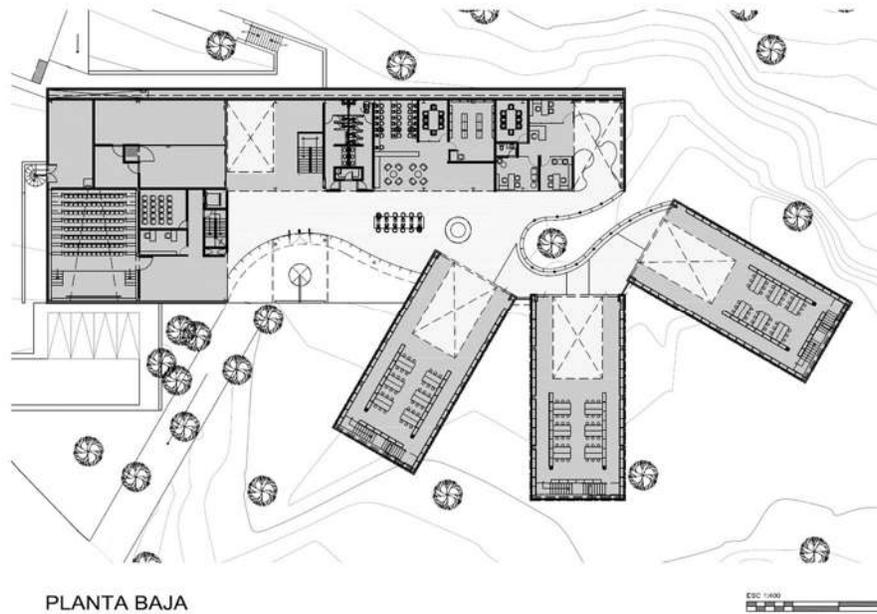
16 Planta Baja, La Biblioteca Central UAEM
